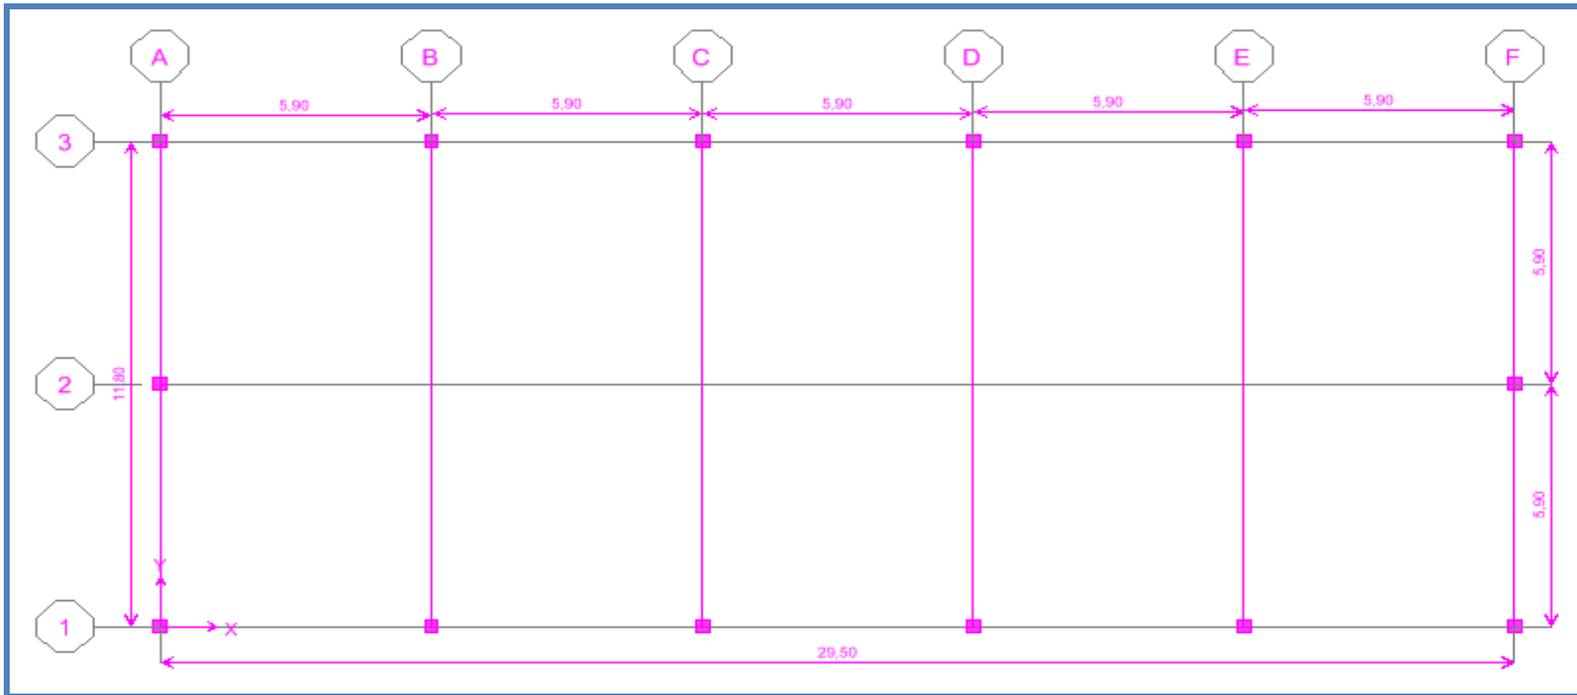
Vista en planta de la bodega de almacenamiento de compostaje.
